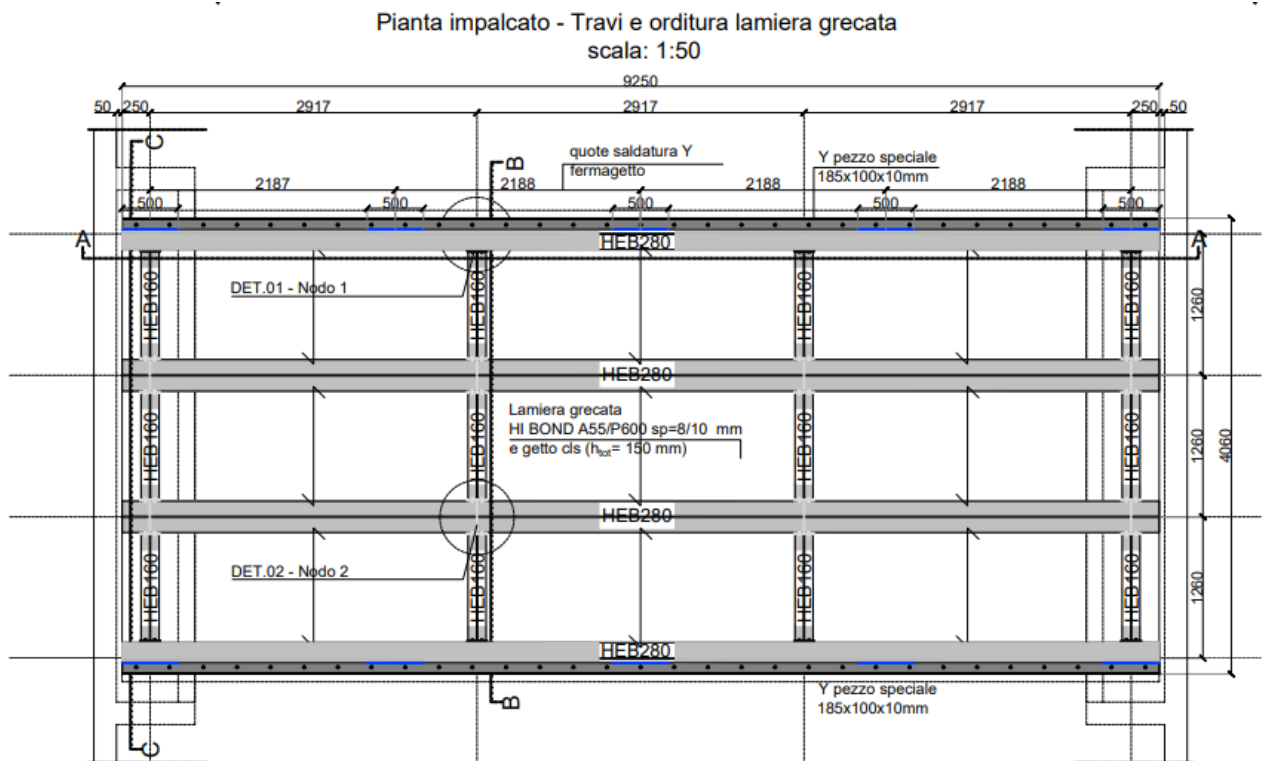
Pianta strutturale impalcato – Ponte pedonale 2B
